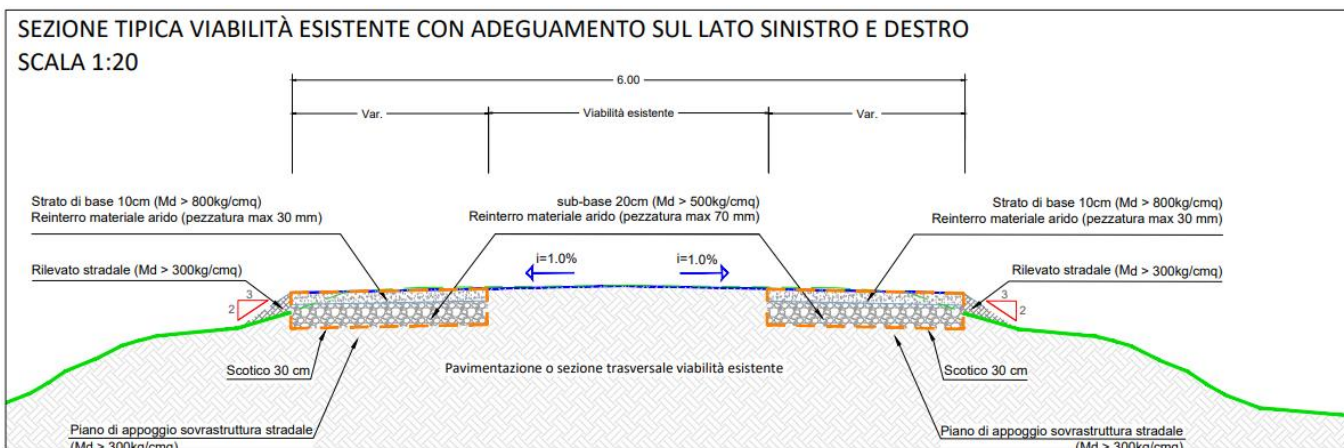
Sezione tipica viabilità esistente soggetta ad adeguamento.
